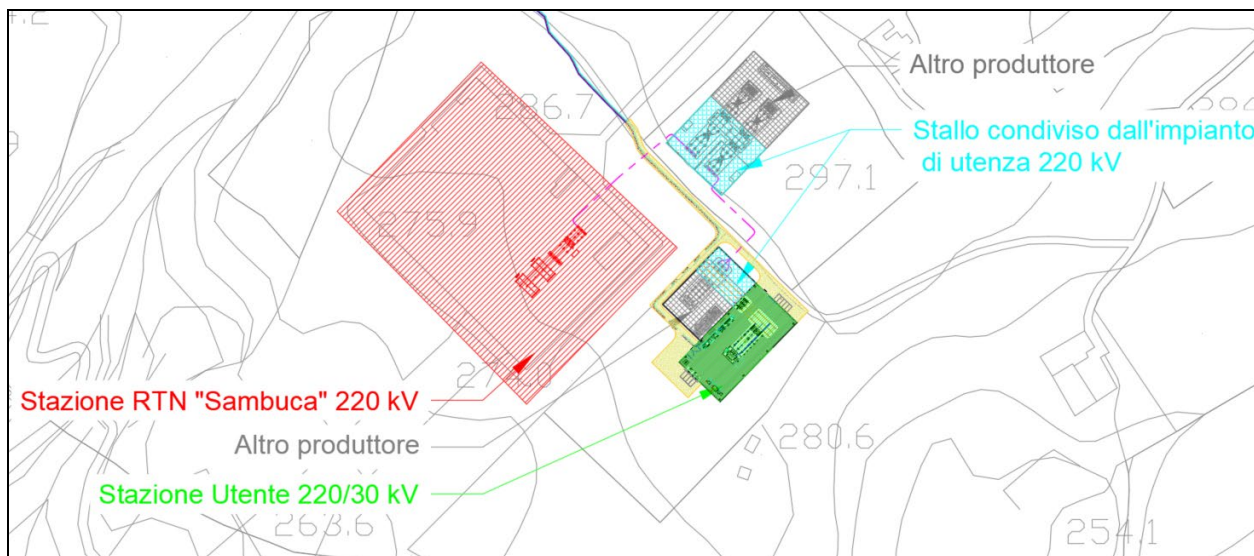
Opere di connessione e di rete - Estratto di inquadramento generale da CTR
